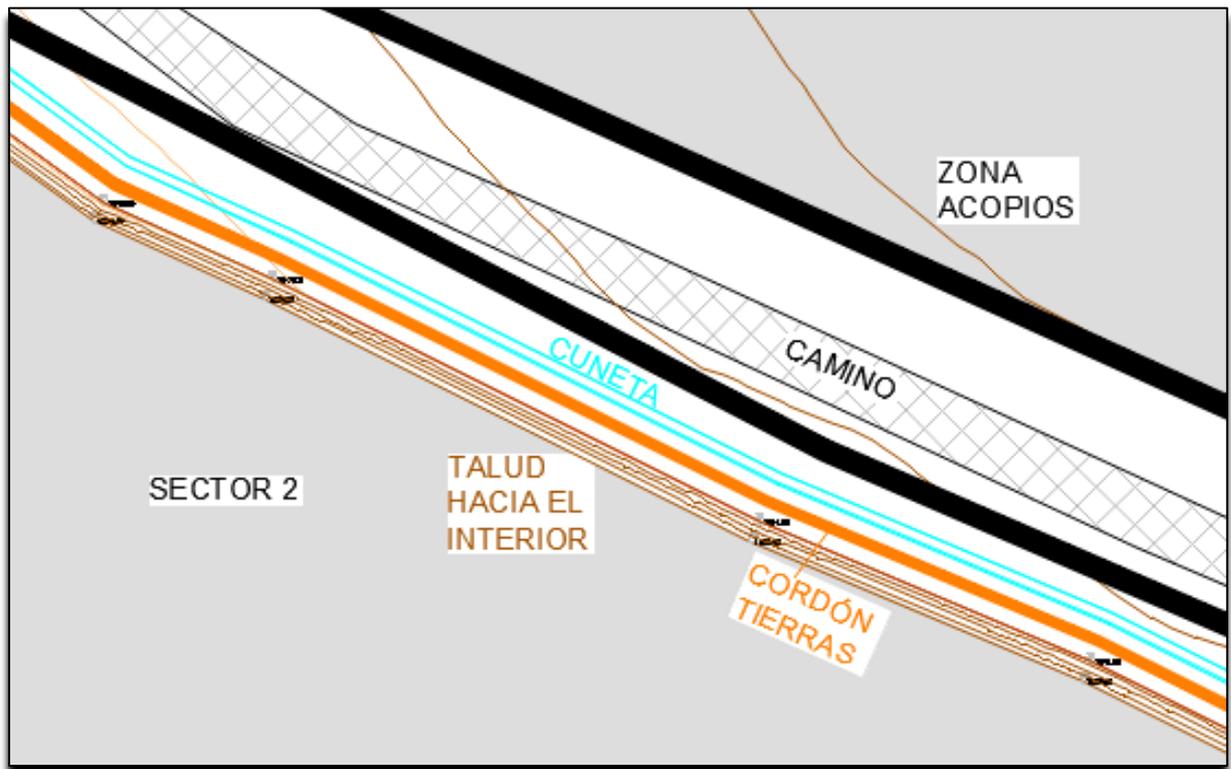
Esquema tipo del perímetro del hueco de excavación. planta.
